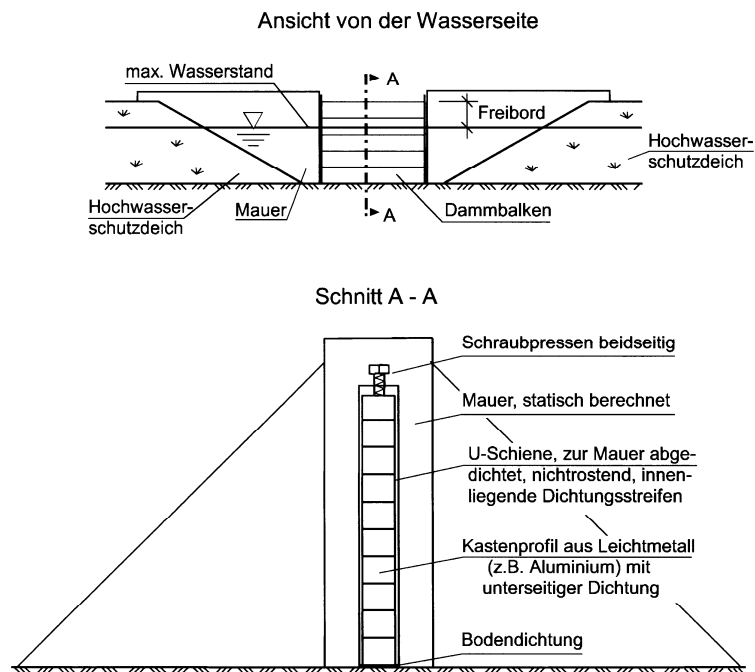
Verschluss einer Dammöffnung mit Dammbalkenelementen [Patt]
